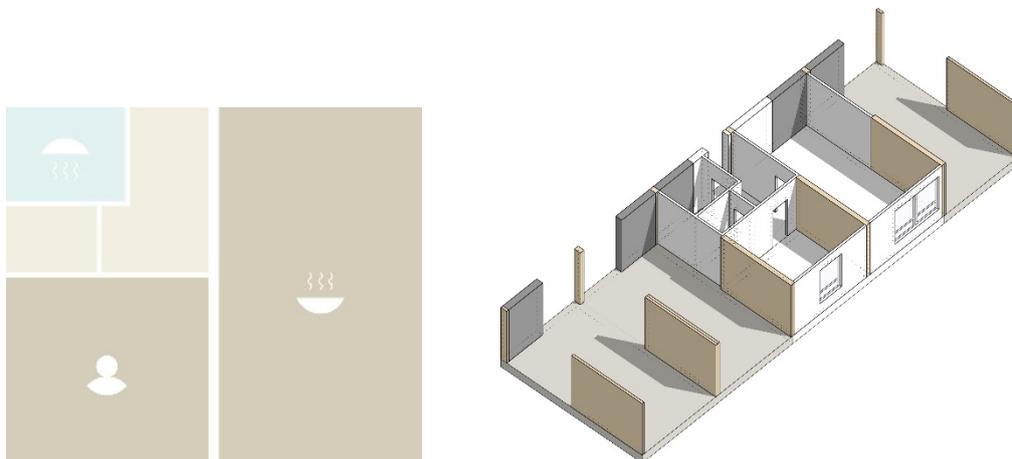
Schema Grundriss (links) und 3D-Darstellung (rechts) 1-Zimmer Micro Wohnung (Architekt Schweizer)
